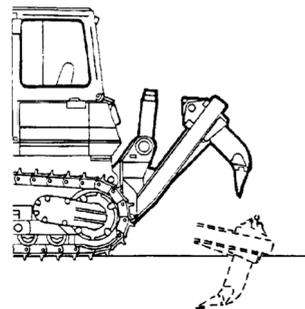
Liebherr Planierraupe mit Schwenkaufreißer (nach [36])
